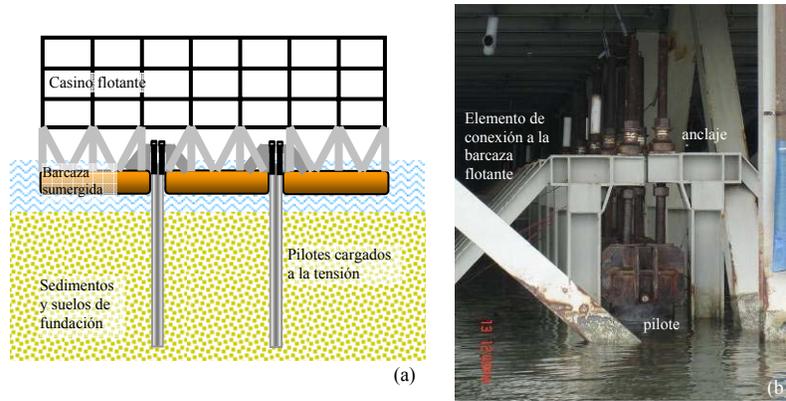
Casinos flotantes anclados con pilotes - (a) Detalle de la fundación - Los pilotes son hincados hasta una profundidad de 20-30 m (Thompson Engineering 2006). (b) Detalle del anclaje de los pilotes a las barcasas de fundación en la estructura del Casino Beau Rivage.
